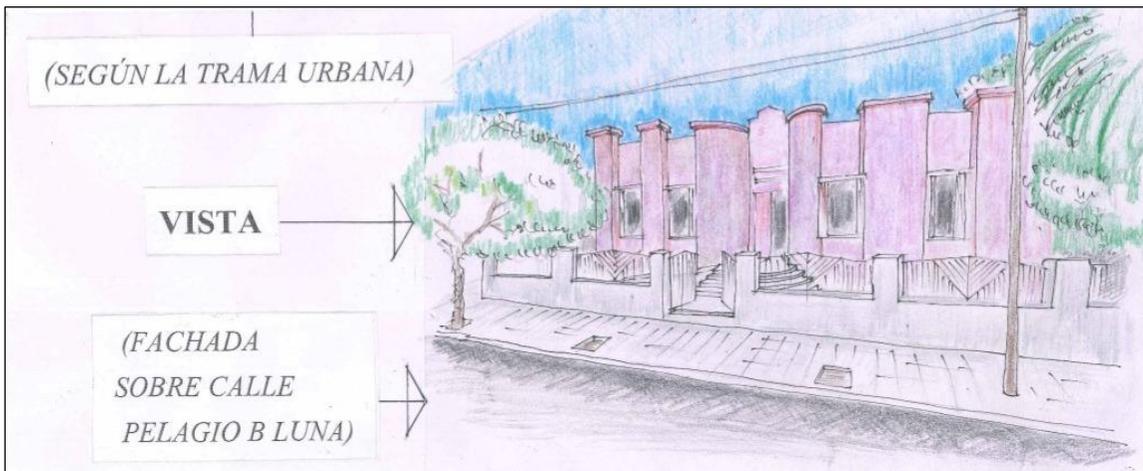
Fachada Sobre Calle Pelagio B. Luna: Esquema Memoria de Planta
